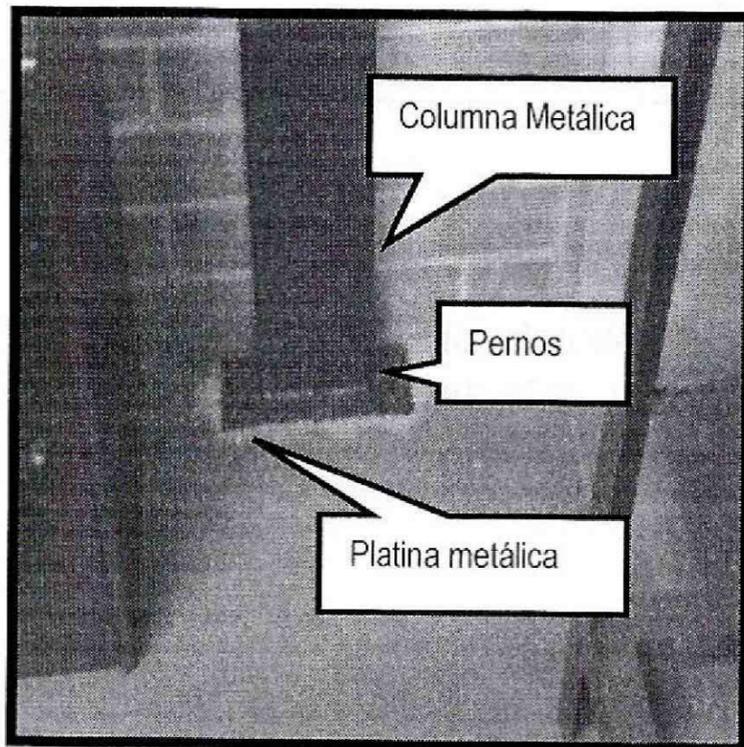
Cerchas metálicas unidas a vigas de concreto por medio de pernos que atraviesan platinas metálicas.
